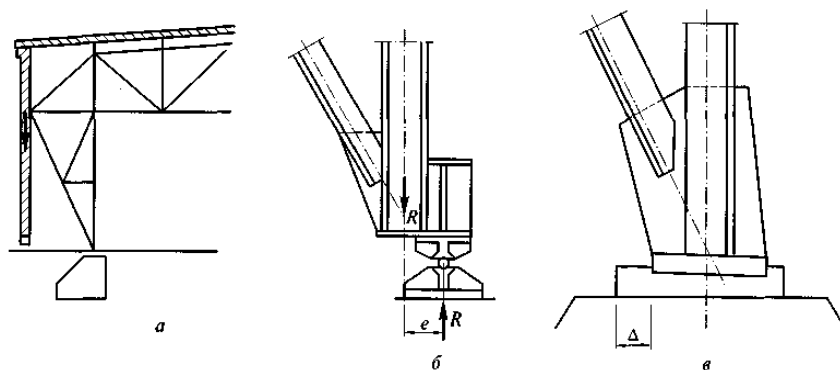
Конструктивні рішення для розвантаження ригеля рами:
